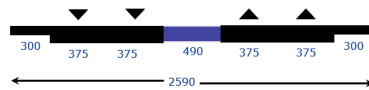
SEZIONE STRADALE TIPO A
